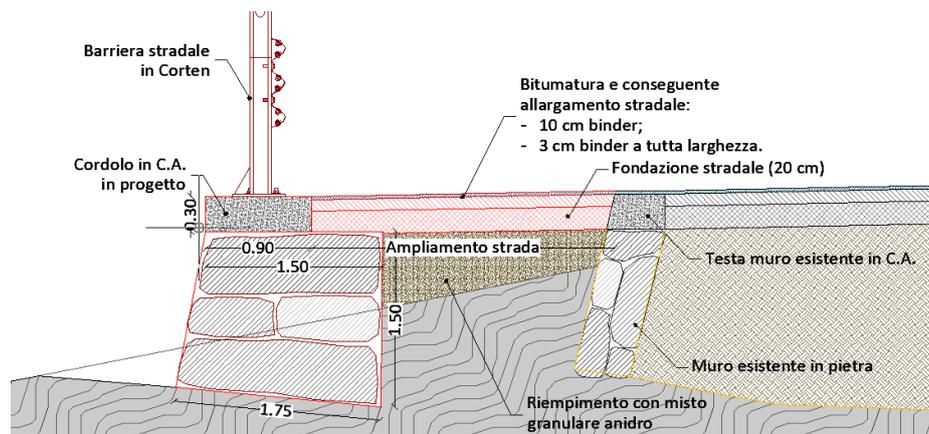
Sezione tratto stradale ampliato con sottomurazione
